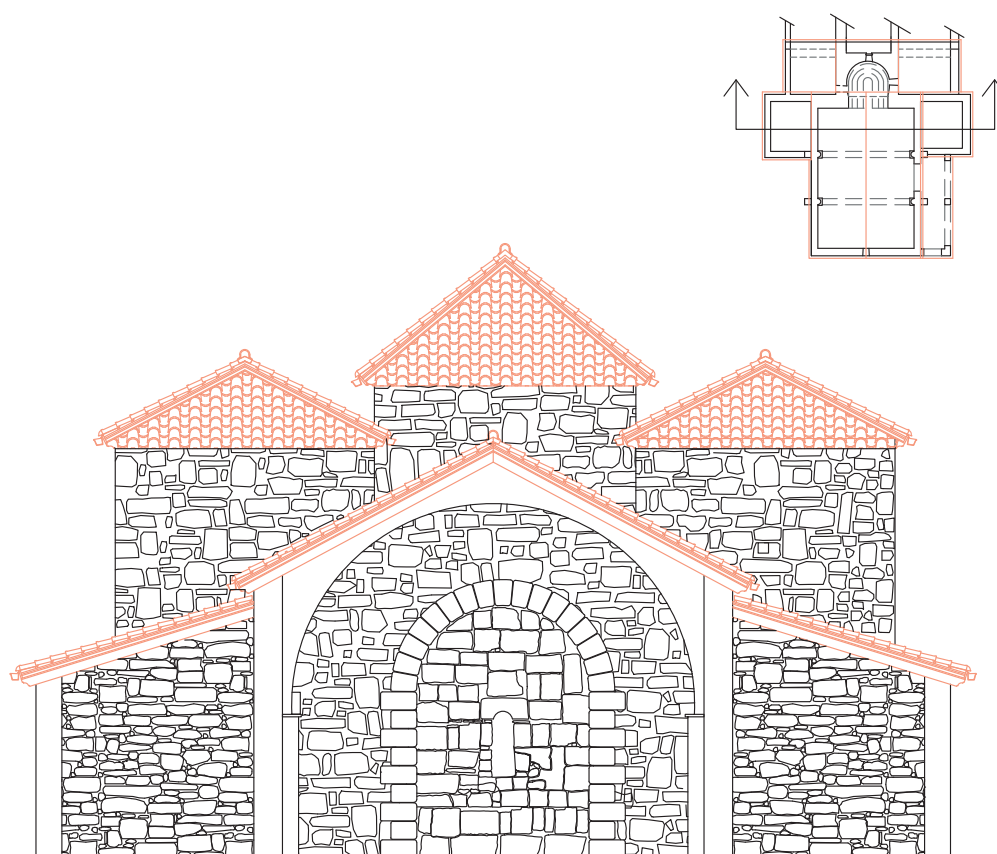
Alzado exterior de la ermita de San Miguel de los Fresnos. Propuesta reconstrucción virtual.
